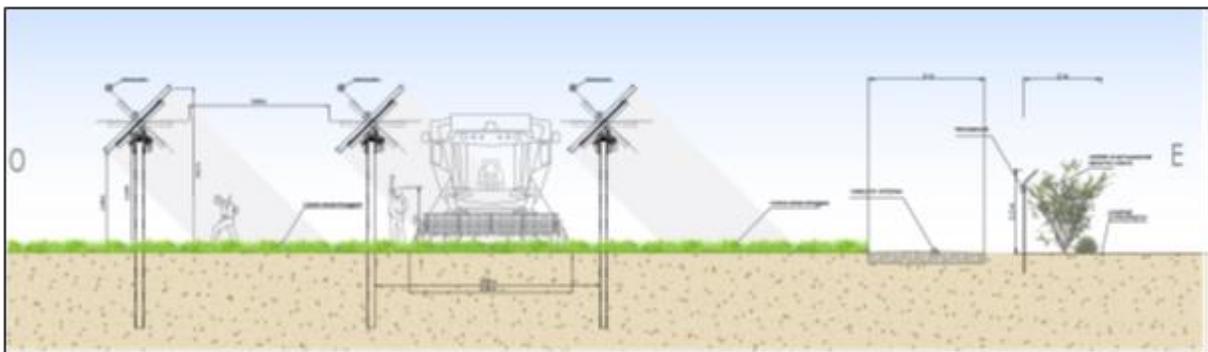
Stralcio elaborati progettuali-Sezione dell'impianto Agrivoltaico
